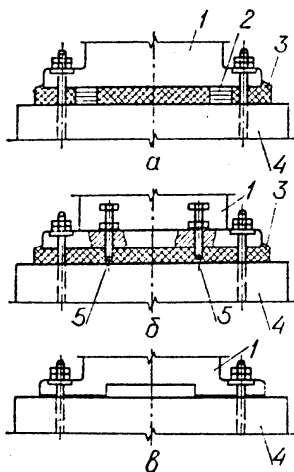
Конструкції стиків «фундамент - устаткування» з обпиранням устаткування: а - на металеві пакети (підкладки); б - на бетонну підливу при “безпідкладковому” методі монтажу устаткування; в - безпосередньо на фундамент; 1 - устаткування; 2 - металеві підкладки (пакети); 3 - бетонна підлива; 4 - фундамент; 5 - регулювальні (установні) болти
